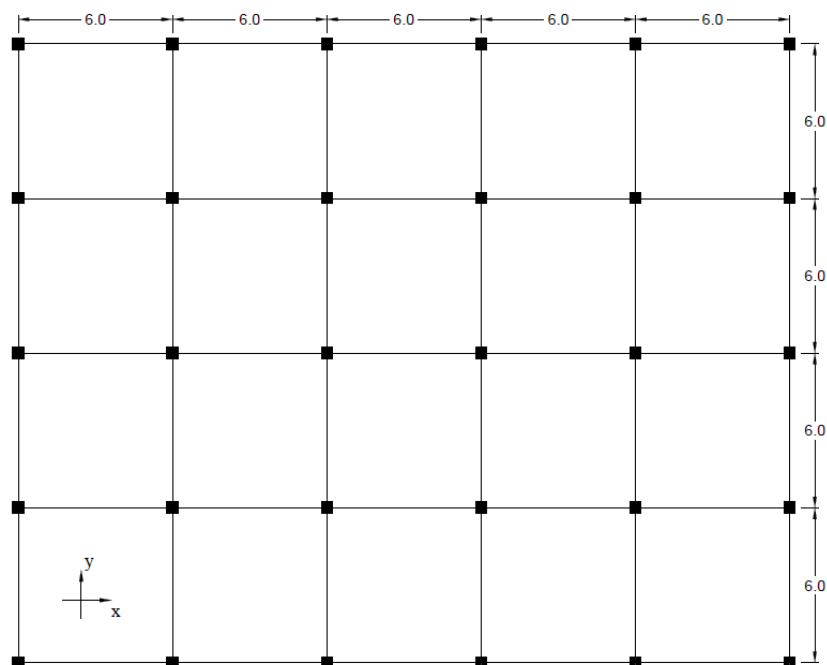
Planta estrutural da estrutura com contraventamento composto por pórticos
